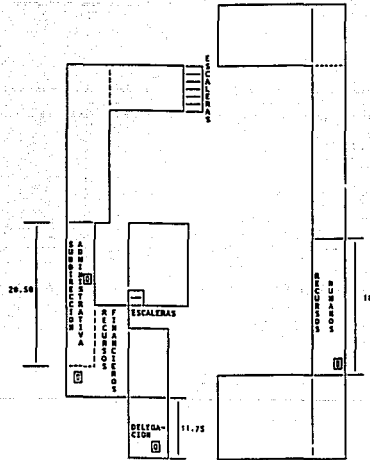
Planos de la Delegación de Colima, Planta Baja.
